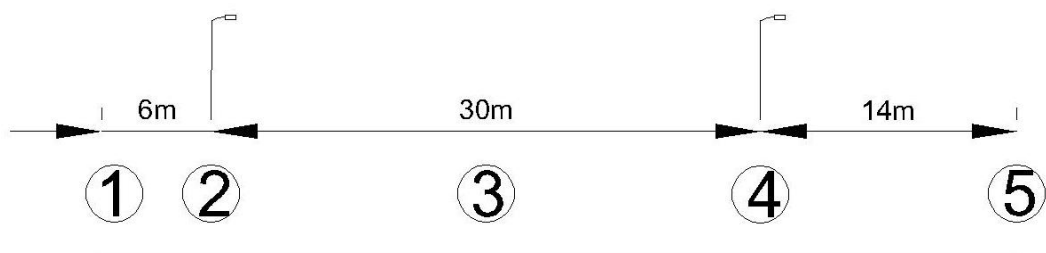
Esquema da localização dos pontos de ensaio no trecho em lajetas pré-fabricadas em betão
